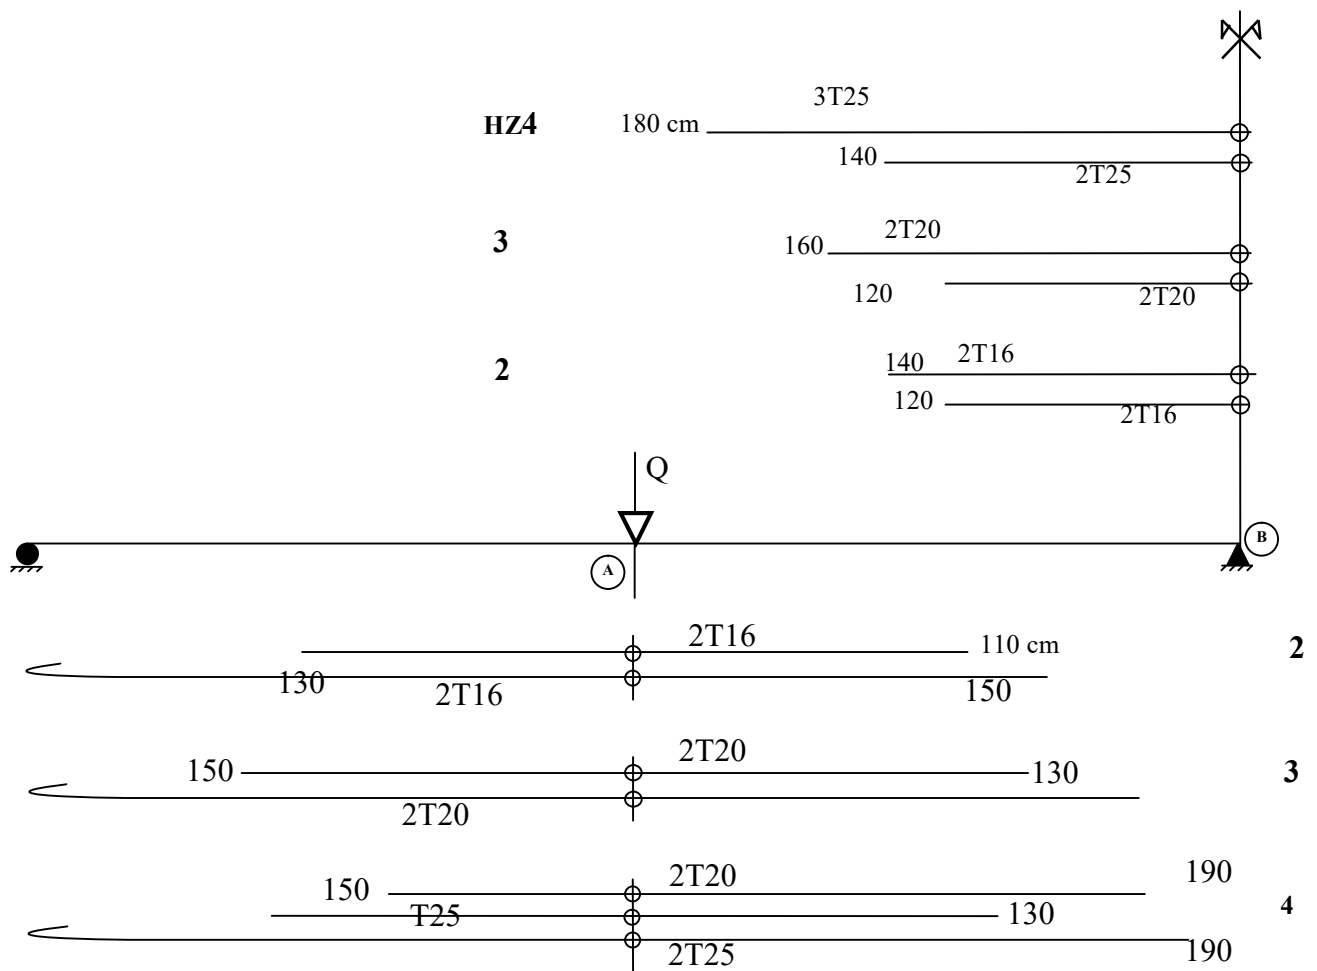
Disposition des armatures longitudinales pour les poutres HZ
